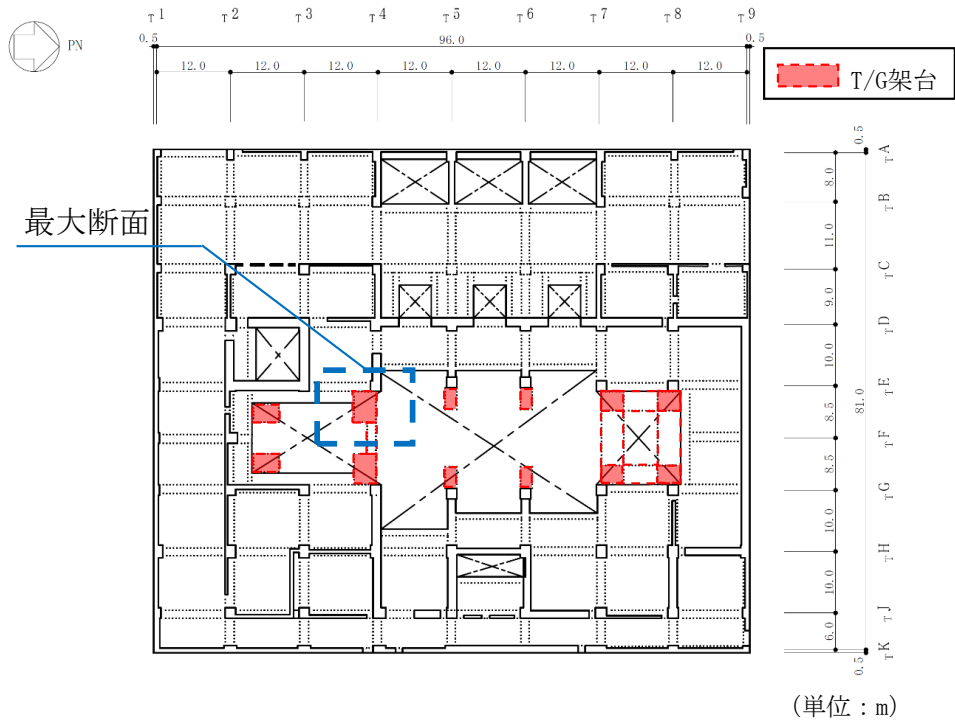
モデル化部の平面図 (1F, T.M.S.L. 12.3m)
